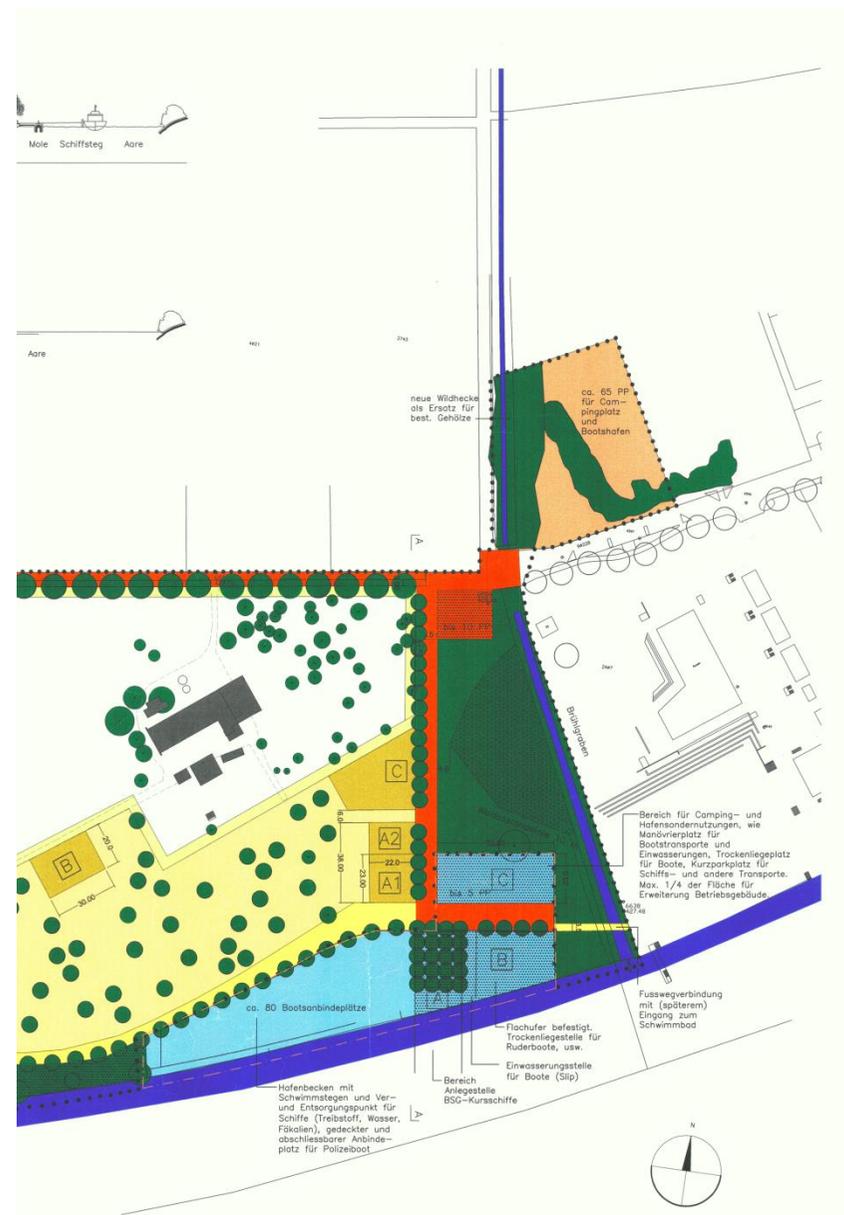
Ausschnitt Gestaltungsplan Campingplatz (rechtsgültig)
